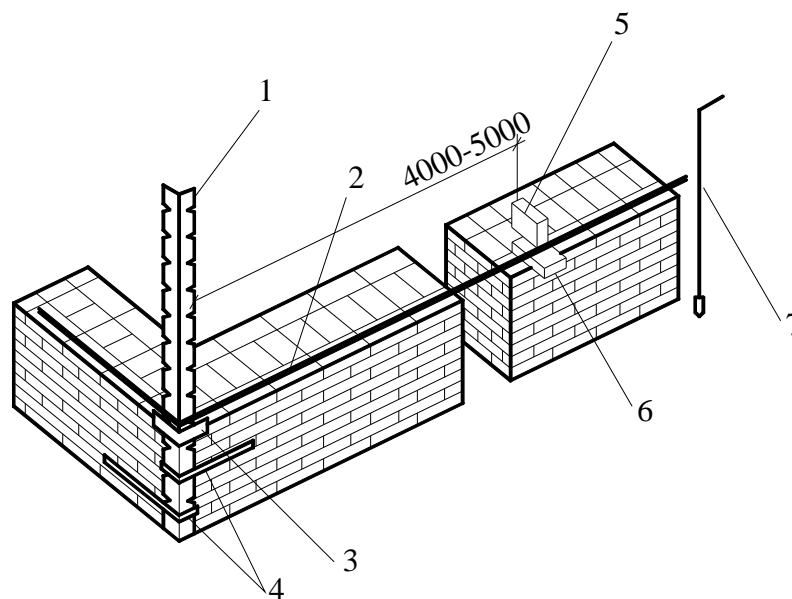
Контрольно-вимірювальний інструмент:
